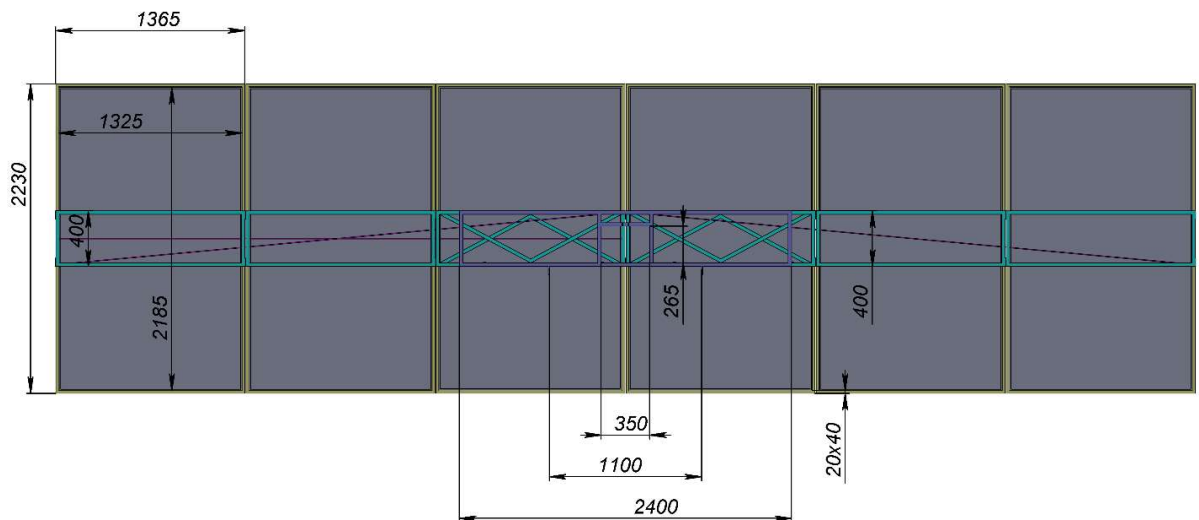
Кріплення ФМ до ферми несучої конструкції
